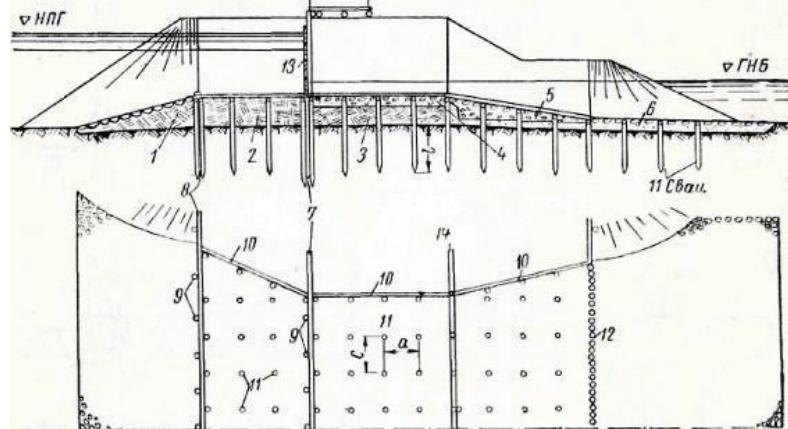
Продольный разрез и план свайного флютбета: 1 – предпонурная подушка (глина); 2 – понур (глина); 3 – водобой (глиnobетон); 4 – обратный фильтр; 5 – слив с уклоном от 1/8 до 1/12; 6 – рисберма; 7 – королевский шпунт; 8 – понурный шпунт; 9 – маячные сваи; 10 – обшивка; 11 – сваи; 12 – свайный частокол; 13 – затворы; 14 – стенка из пластин по сваям
